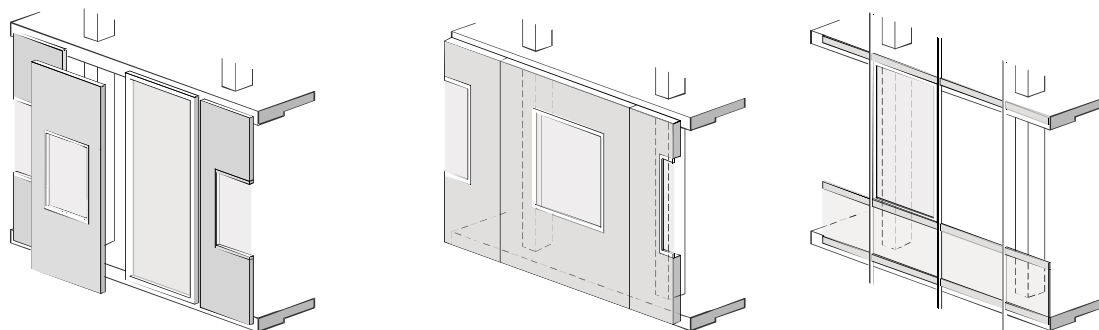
Ausschnitte Fassaden mit nicht tragenden Außenwänden
